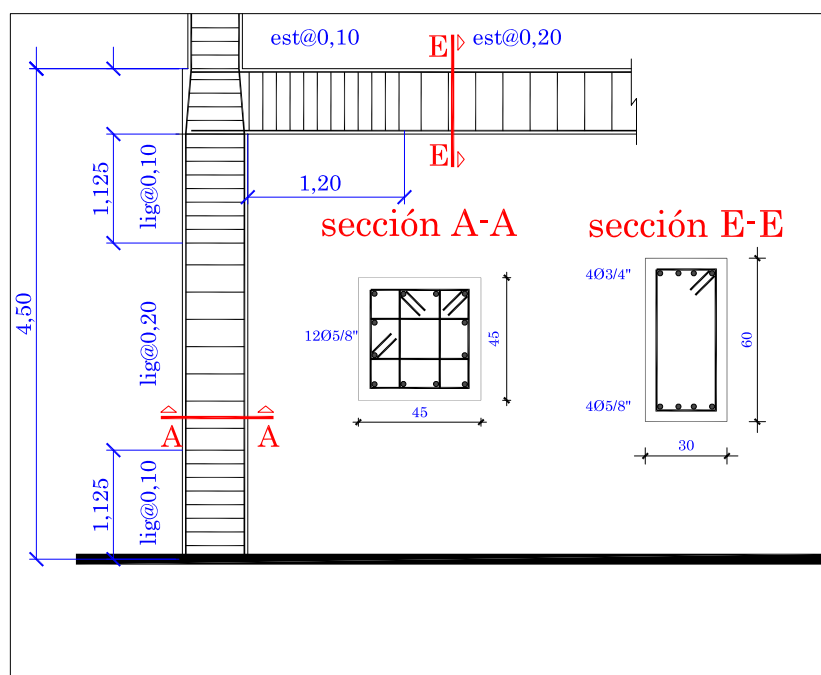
Detalle de armado de los elementos de pórtico de tres plantas
